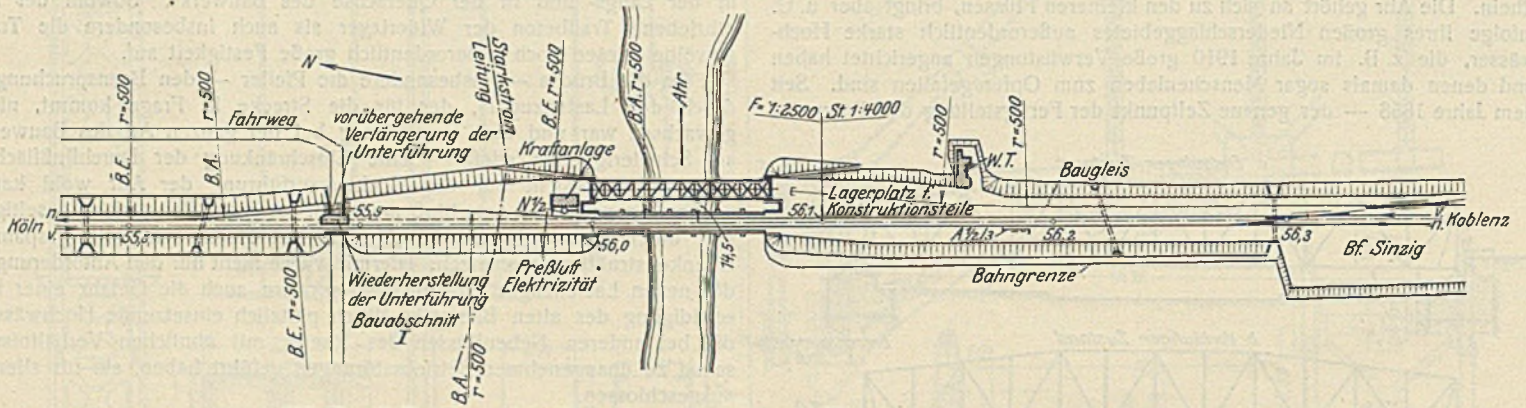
II. Bauabschnitt: Herstellung des eisenen Unterbaues in seiner vorläufigen Lage.
